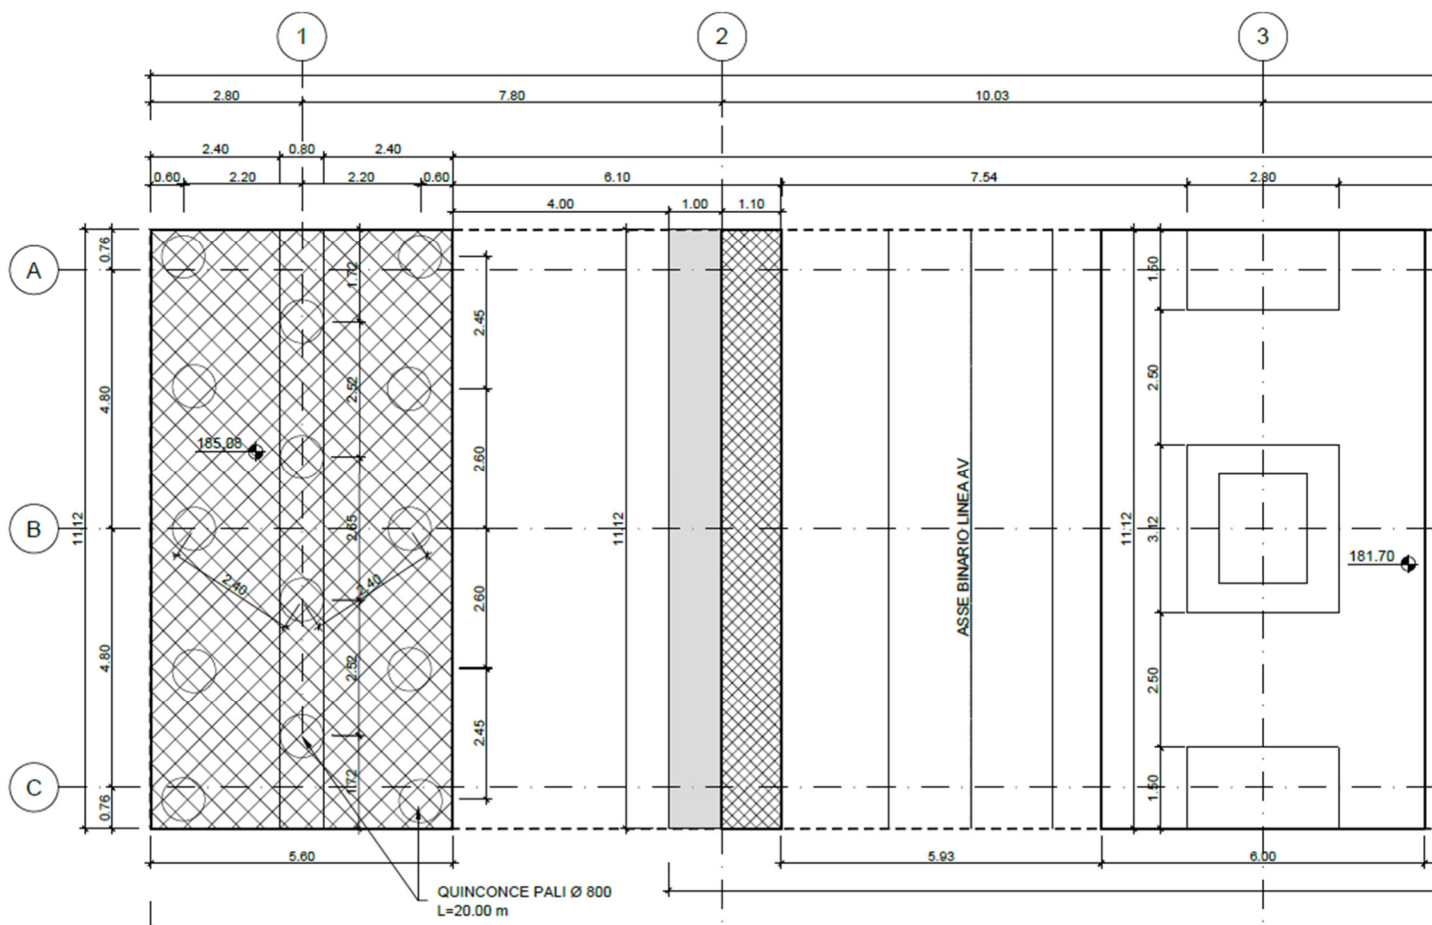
Dettaglio fondazioni, plinto su pali, muri trincea e nuclei scale/ascensori
